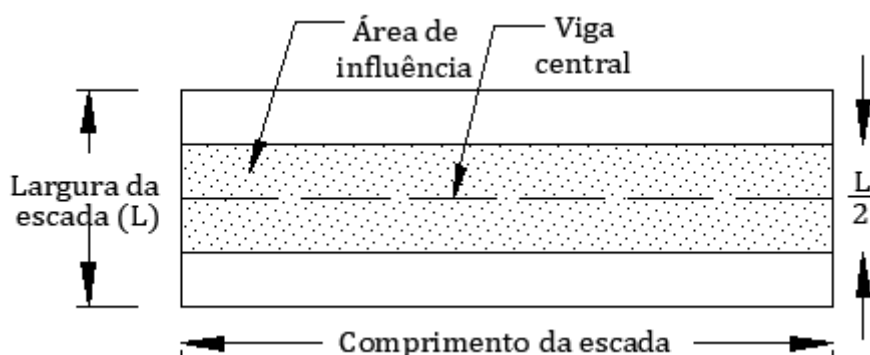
Modelo simplificado da área de influência da viga central utilizada para cálculo da armadura longitudinal de uma laje (Fonte: autor).
